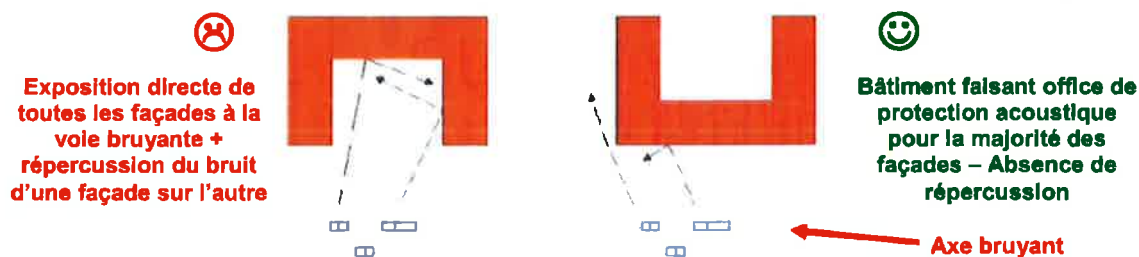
Exemple 1 de positionnement à adopter pour les nouveaux bâtiments à construire
